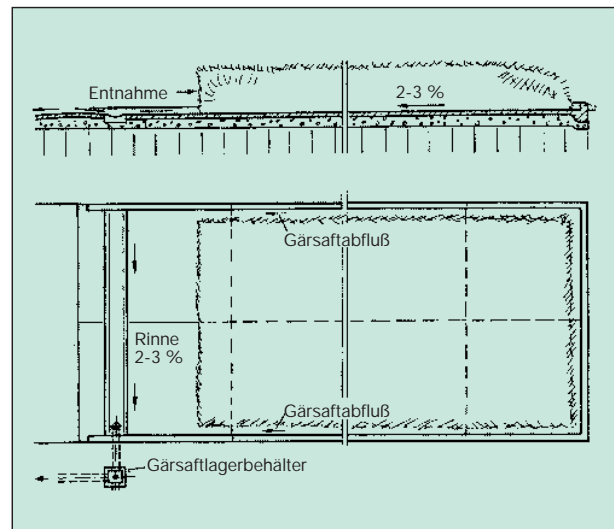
Silierplatte; Grundriß und Schnitt [13]
